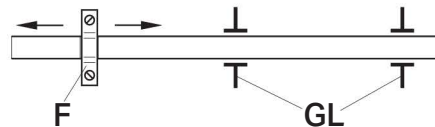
Befestigung durchgehender Rohrleitungen mit nur einem Fixpunkt
